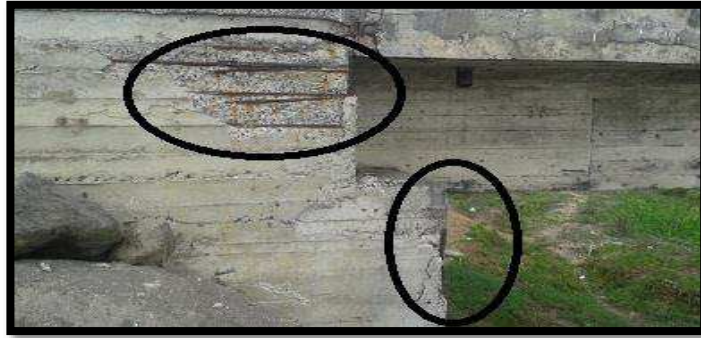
Desprendimientos del hormigón y corrosión en el acero de refuerzo.
